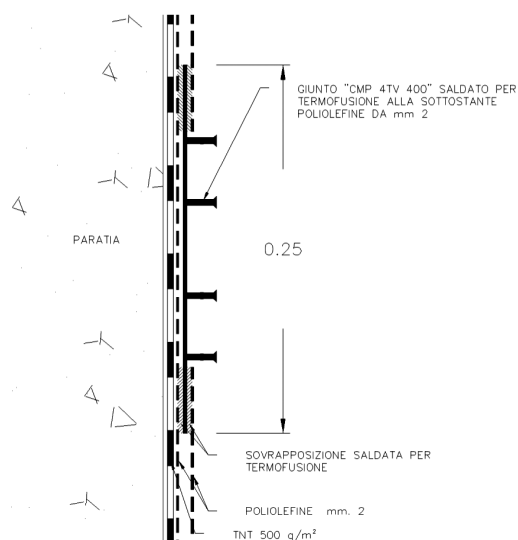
Dettaglio posa giunto in WPS. Detail of positioning of joint in WPS. ("CMP 4TV 400" joint of 2 mm welded by thermofusion to the polyolefin below; overlap welded by thermofusion; 2 mm polyolefin).
